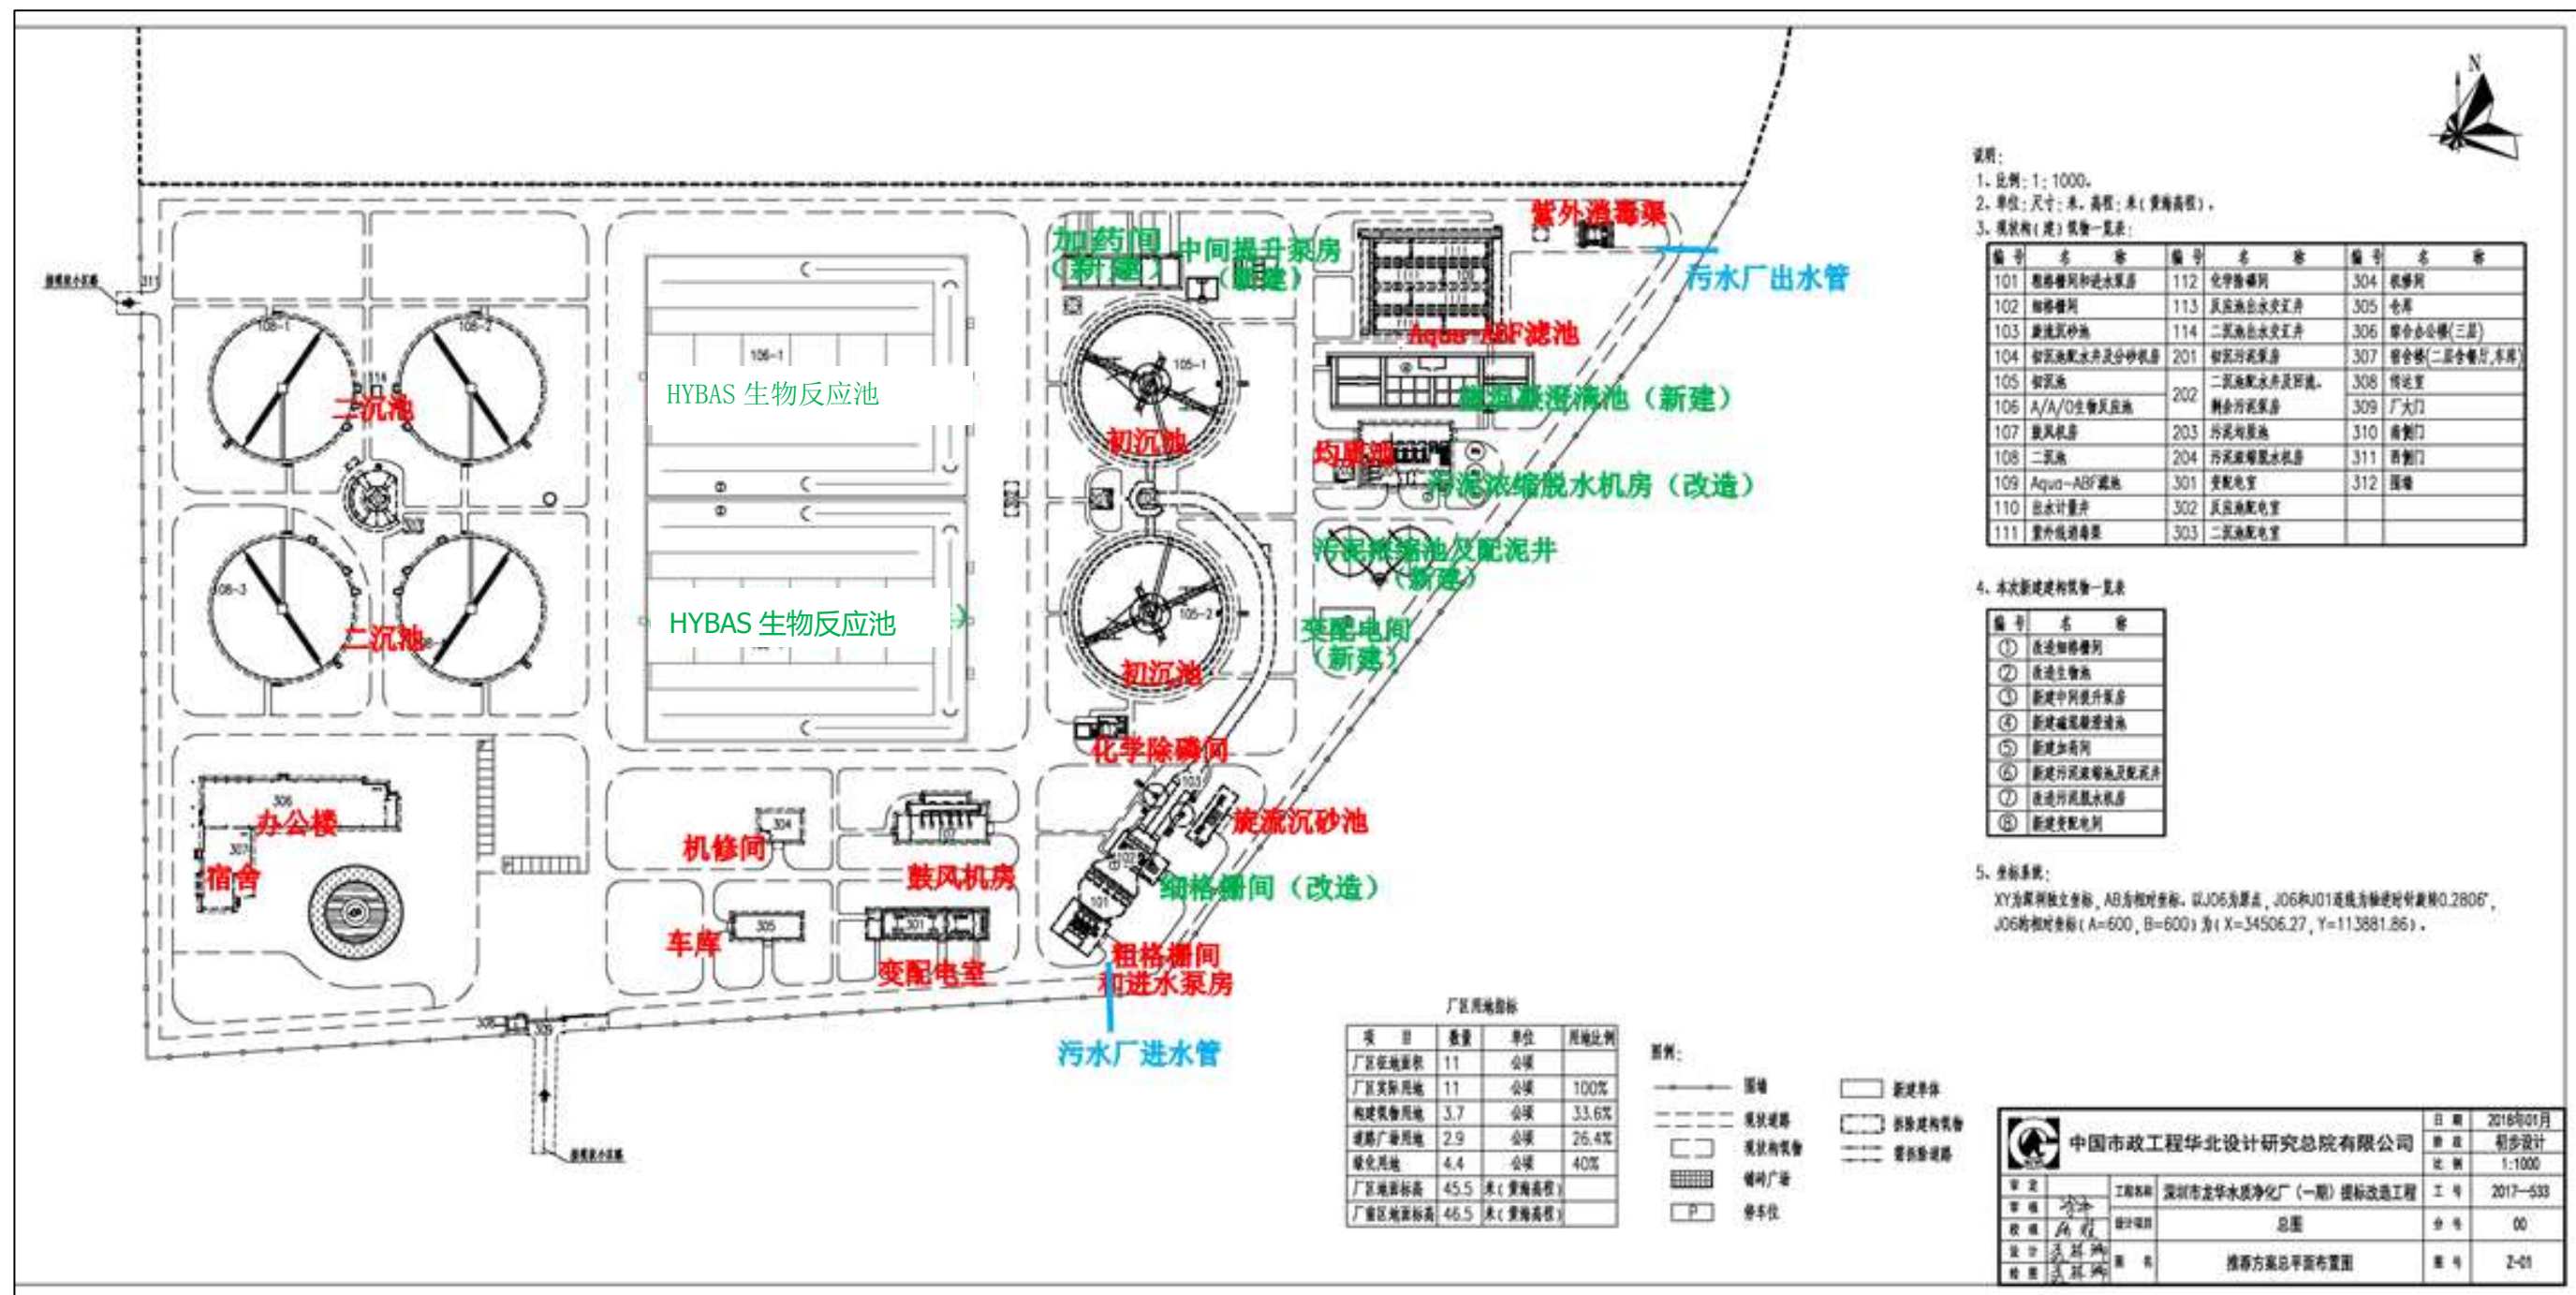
提标改造后总平面布置图 (红色字体为原有构筑物, 绿色为提标改造内容)
